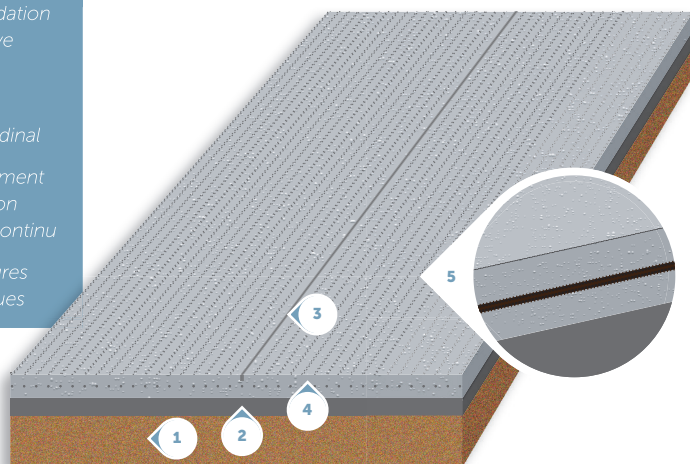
Chaussée composite avec un revêtement Béton Armé Continu BAC et une couche de fondation GB3
